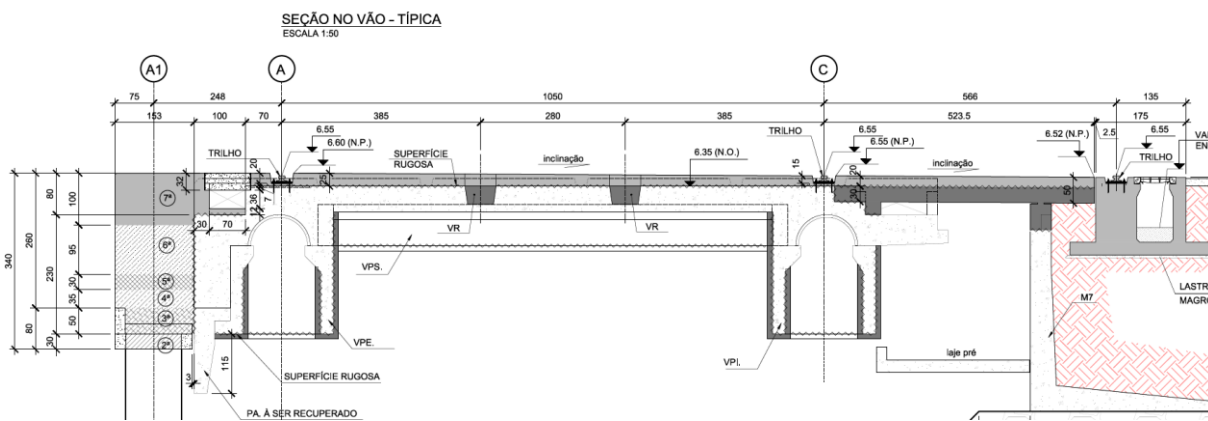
Corte transversal - formas da superestrutura com reforços propostos (seção típica).
